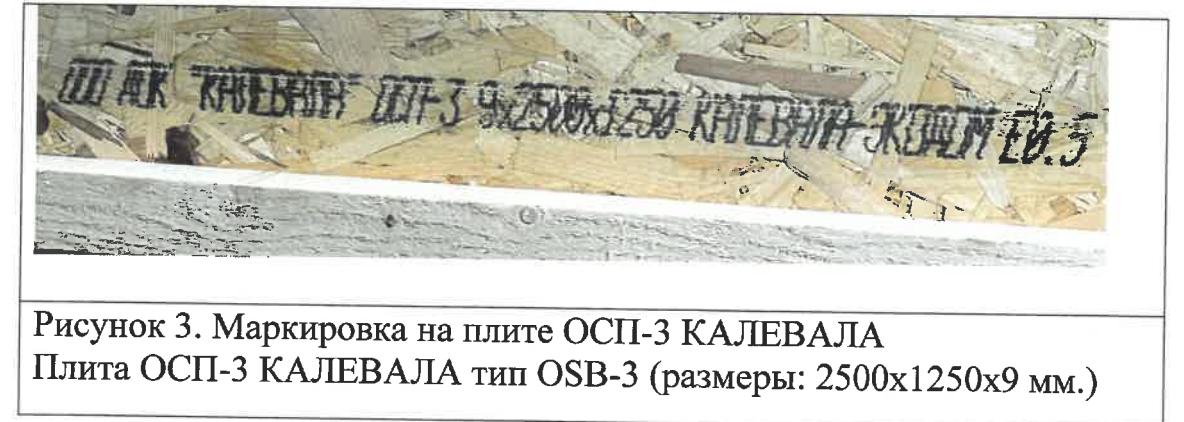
Маркировка на плите ОСП-3 КАЛЕВАЛА
